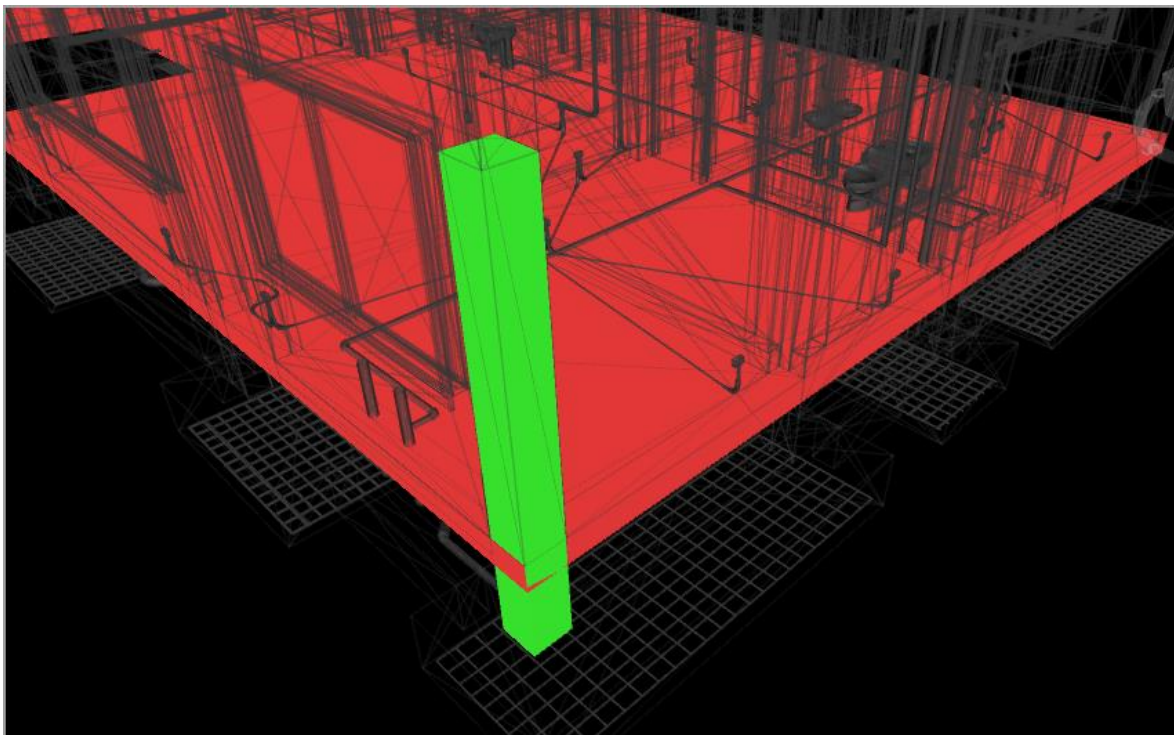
Interferencia entre losa de concreto y columna de confinamiento.
